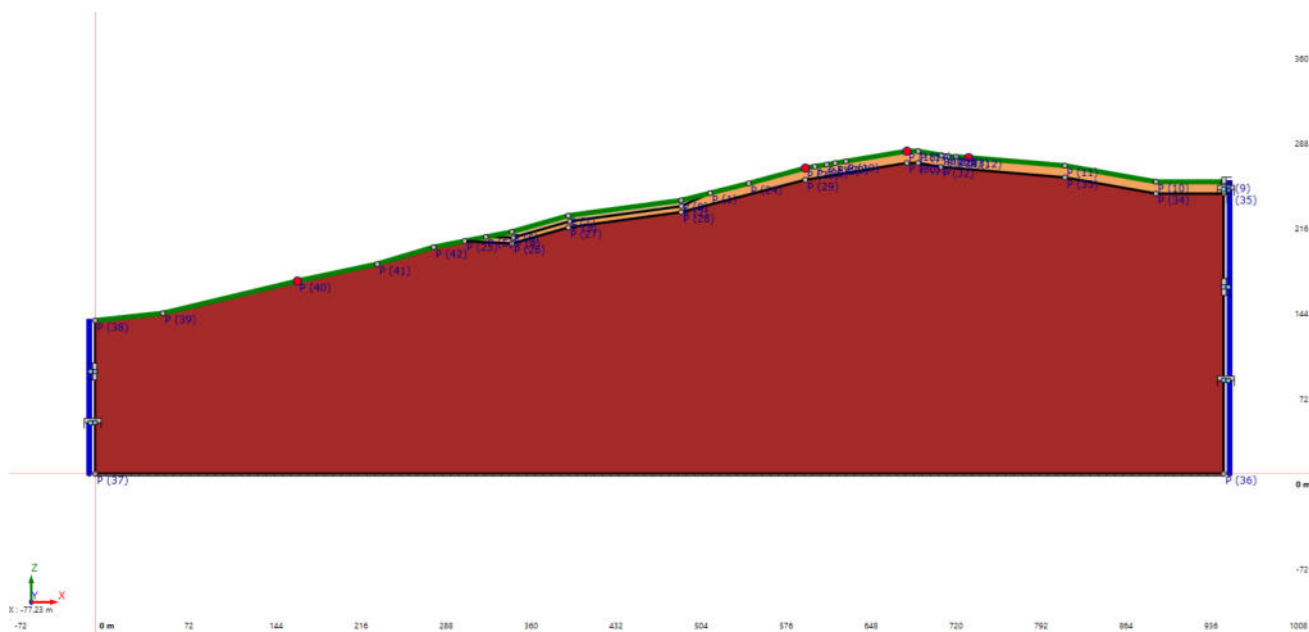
Sezione corrispondente alla manifestazione di interesse 187
